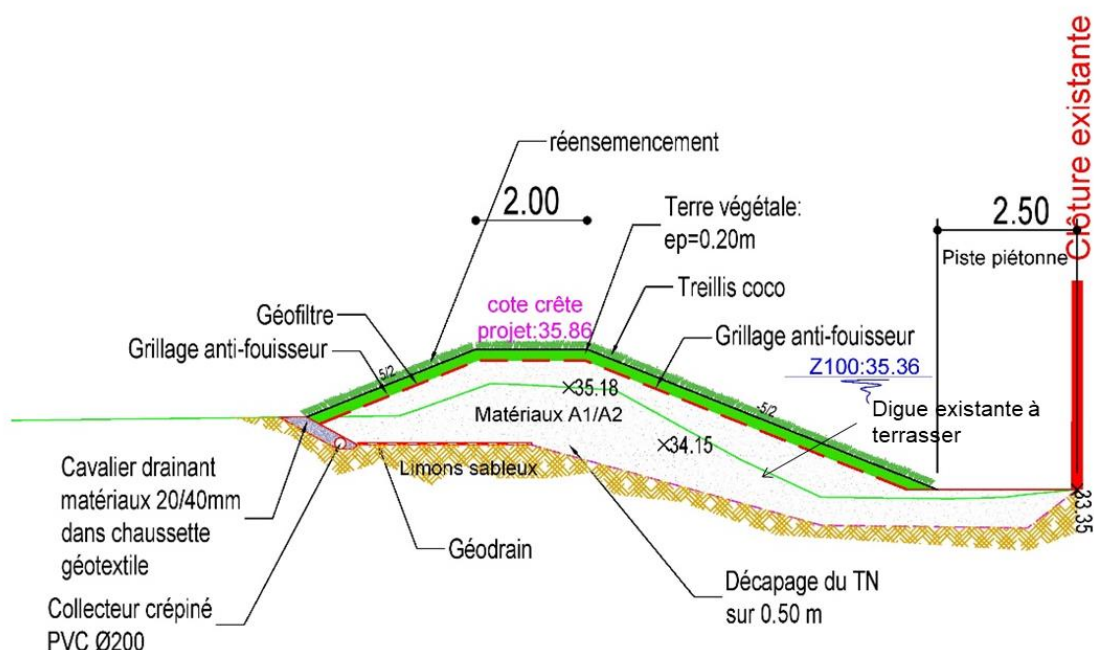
Profil en travers de la digue 1 au PK 100
